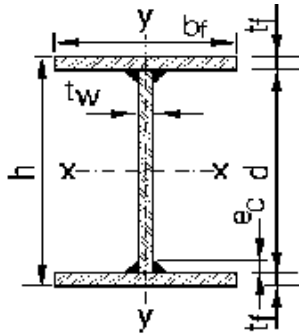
Seção transversal genérica de um perfil metálico soldado (Série VS)
